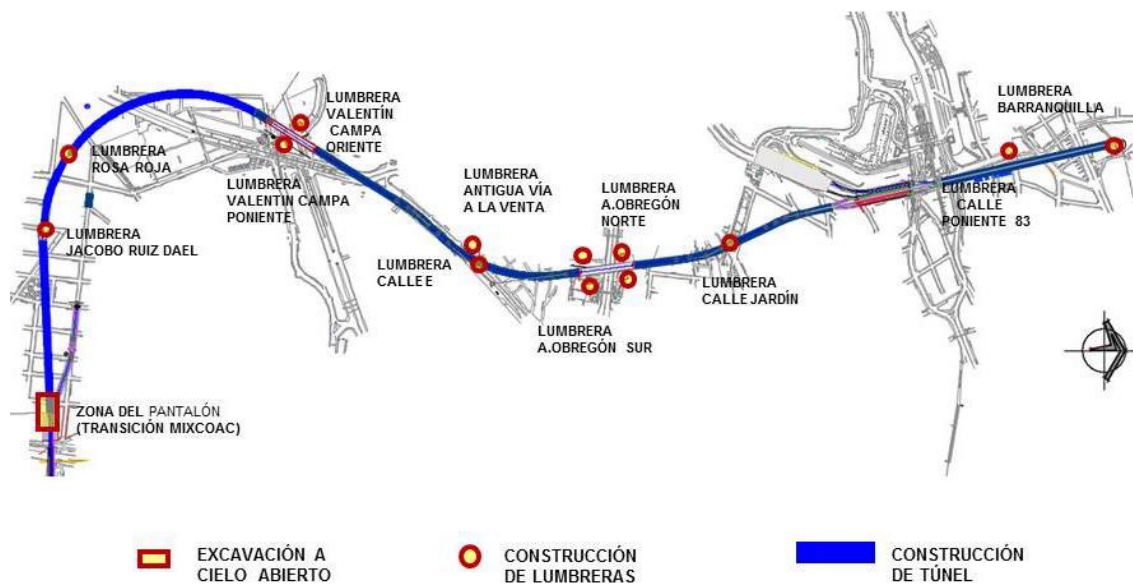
Vista en planta de la localización de lumbreras. Fuente: (Dirección General de Construcción de Obras para el Transporte, 2018).
